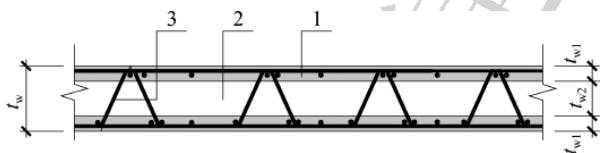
桁架钢筋叠合板式剪力墙构造示意
